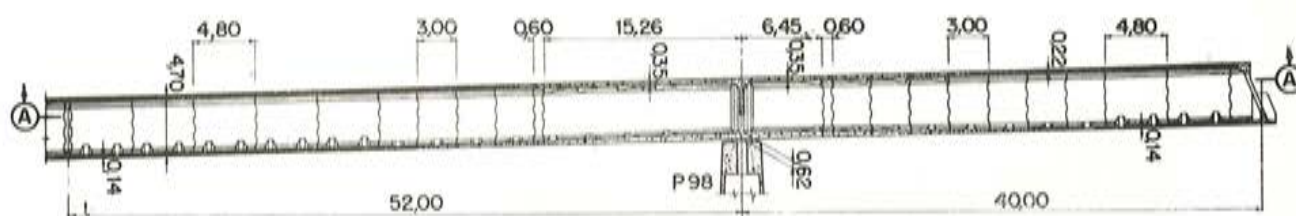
Secciones de los dobles voladizos de 92 m de longitud.
